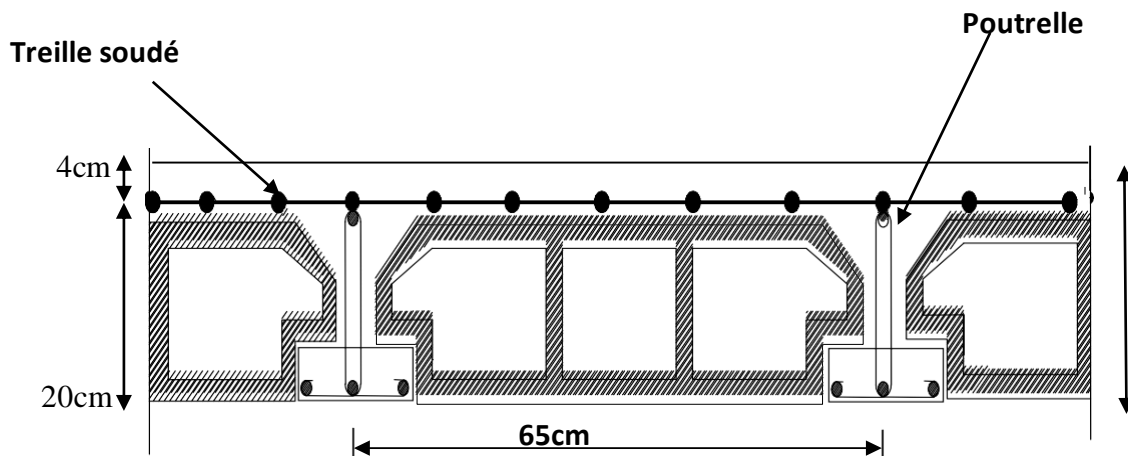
coupe transversale d'un plancher en corps creux.
